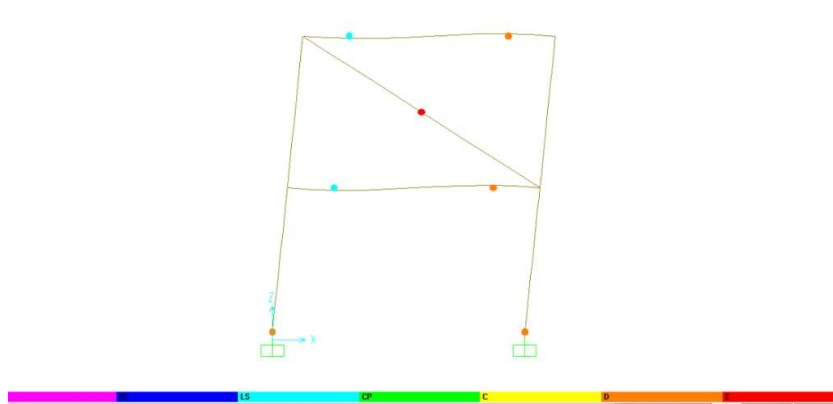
Mecanismo de falla en pórtico de hormigón armado relleno de mampostería del modelo 2M-A.
